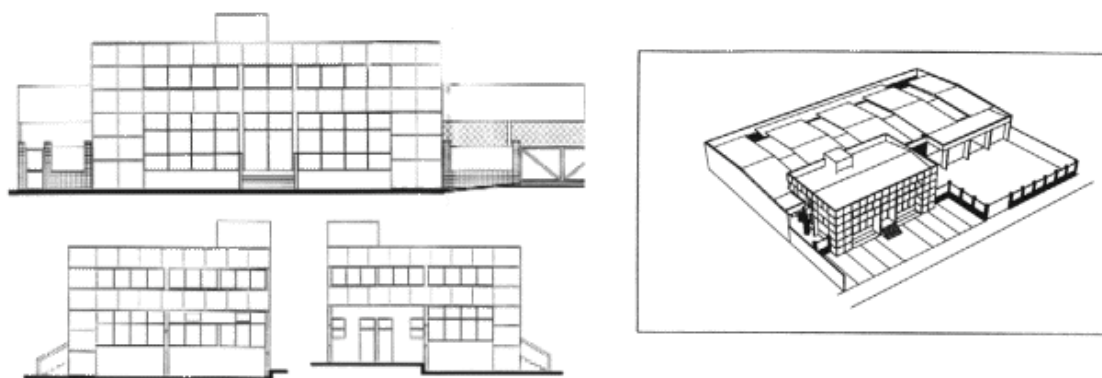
MARMOGRAN - Fachadas Este, Norte e Sul e vista aérea do conjunto
